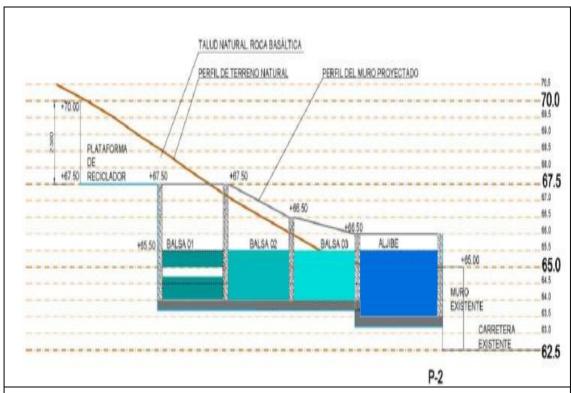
Plano de secciones de las balsas de recepción y aljibe a ejecutar (fuente: Modificado del Planta de Recuperación de Áridos.
